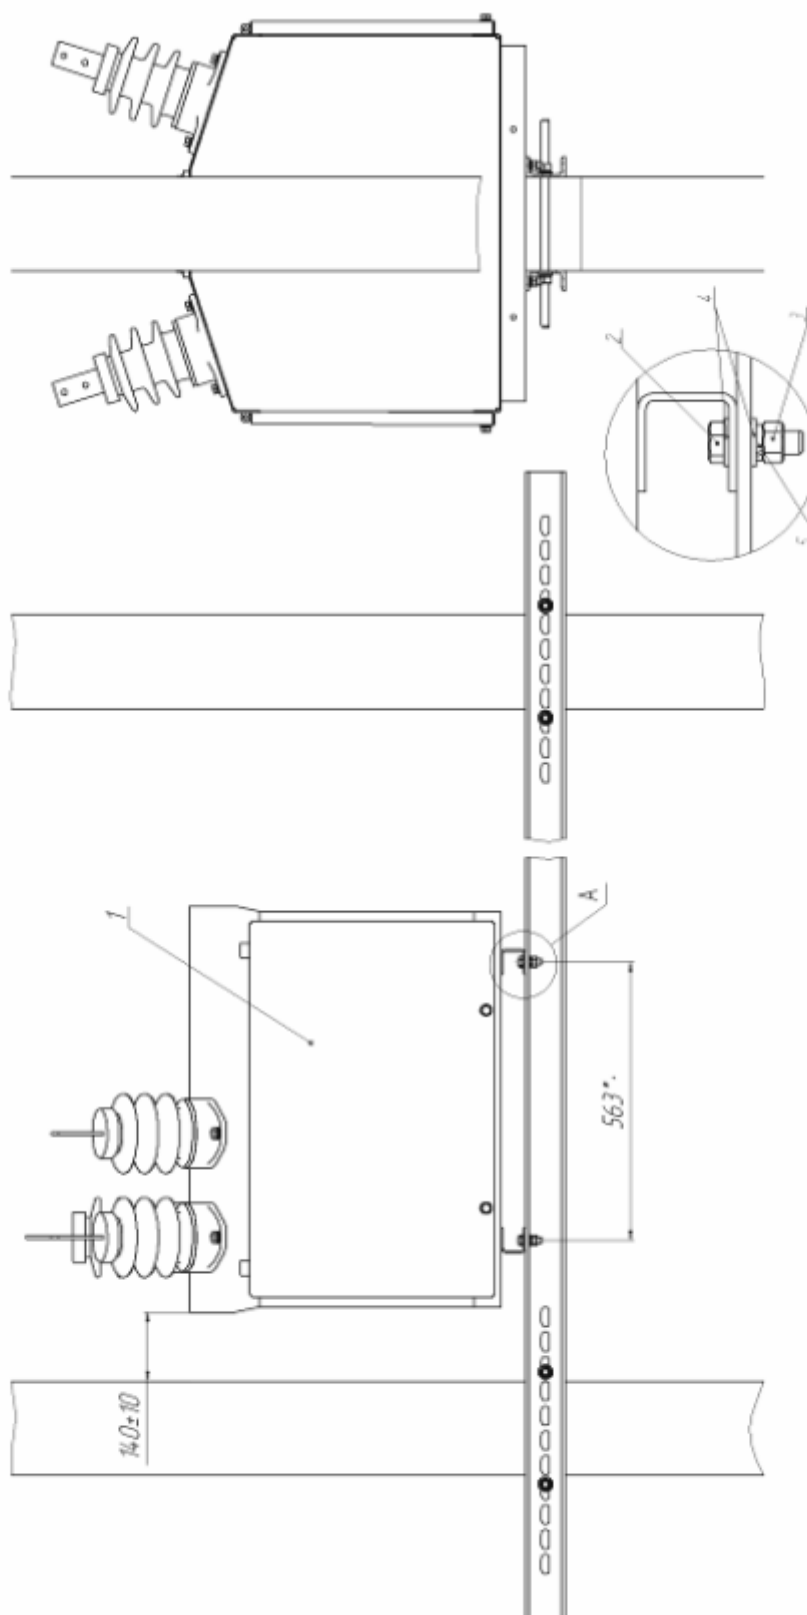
КРЕПЛЕНИЕ ВМ НА ОПОРНОЙ ПЛОЩАДКЕ
